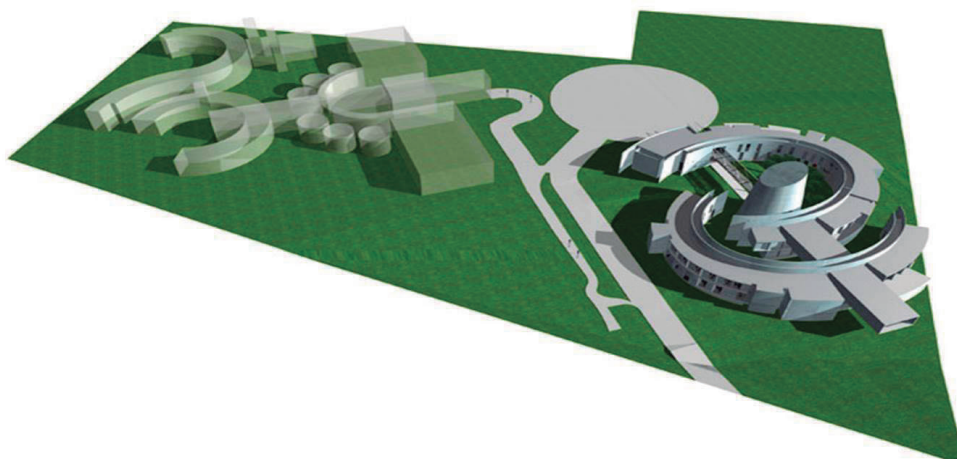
Vista en 3D de Proyecto de El Colegio de San Luis. Fuente: Zendejas arquitectos.com.
